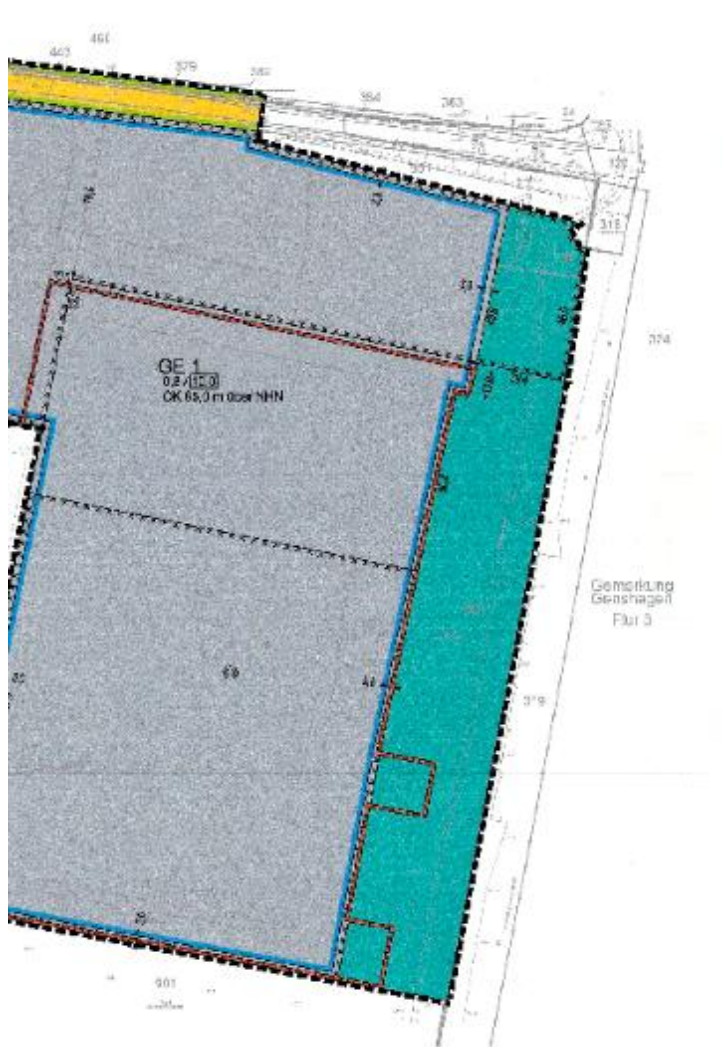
Ausschnitt B-Plan Nr. 44-2 Teilfläche 1 -Festsetzung „Fläche für Wald“
